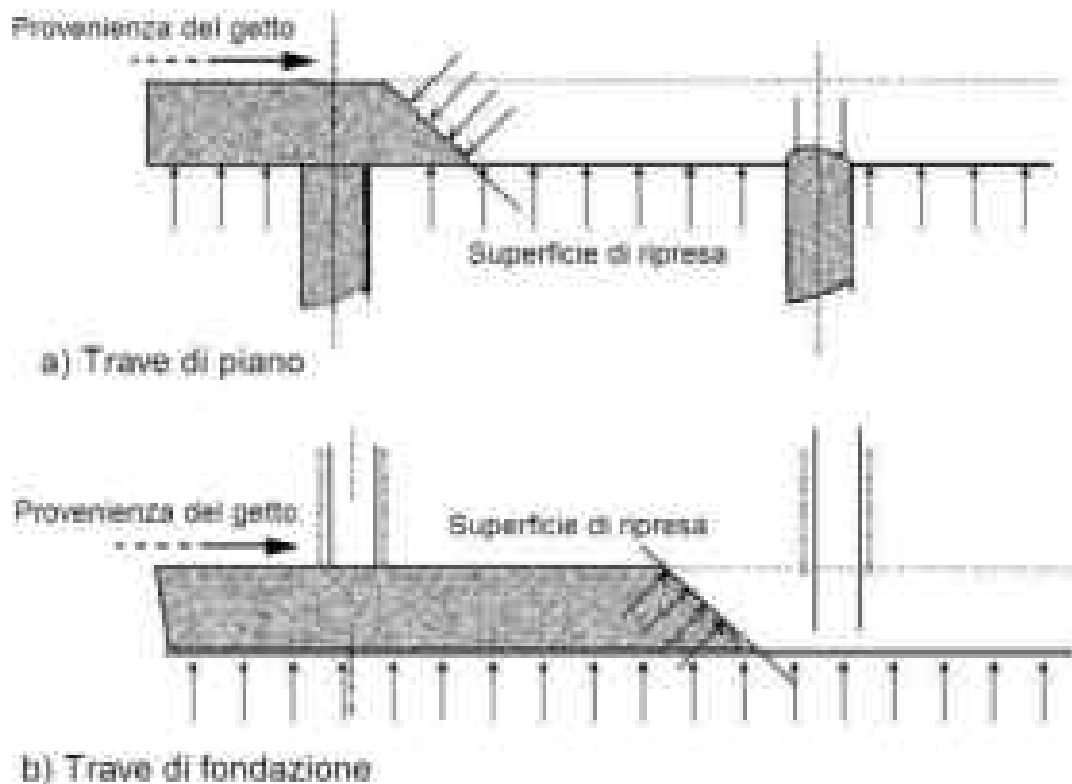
Modalità di ripresa del getto in travi di piano e di fondazione
